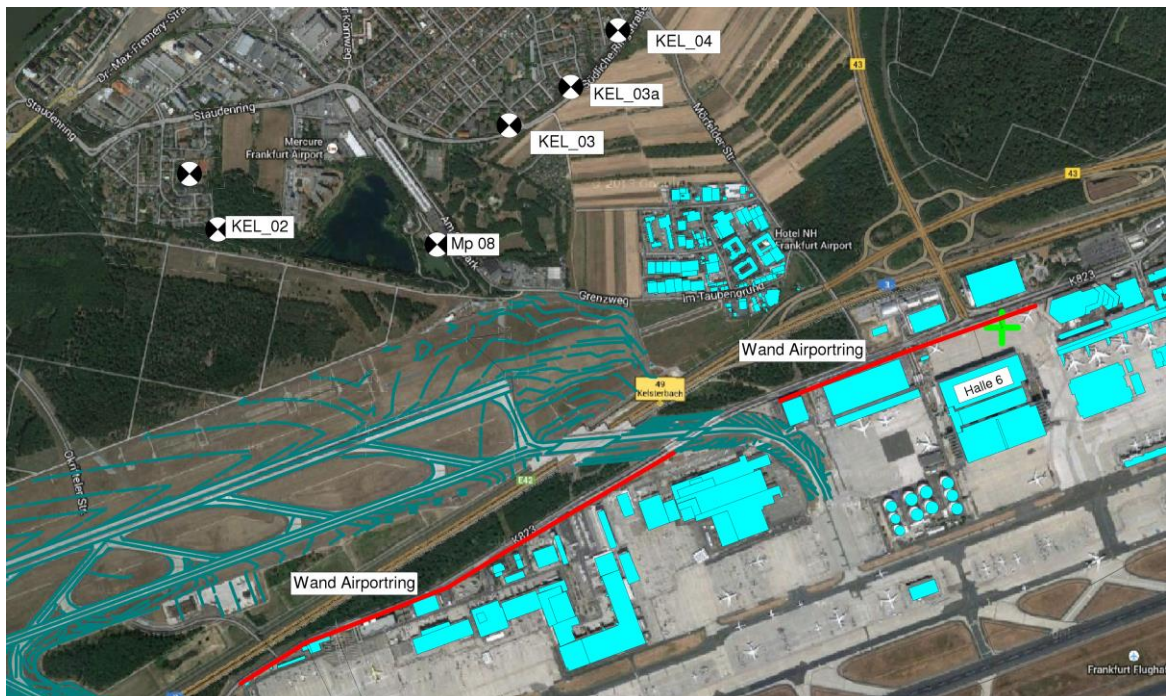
Lageplan Flughafen Frankfurt Main (Stand 1968) mit den geplanten, neuen Hallen des Frachtzentrums und Lage der vorgeschlagenen Schallschutzwand entlang des Airportrings.
